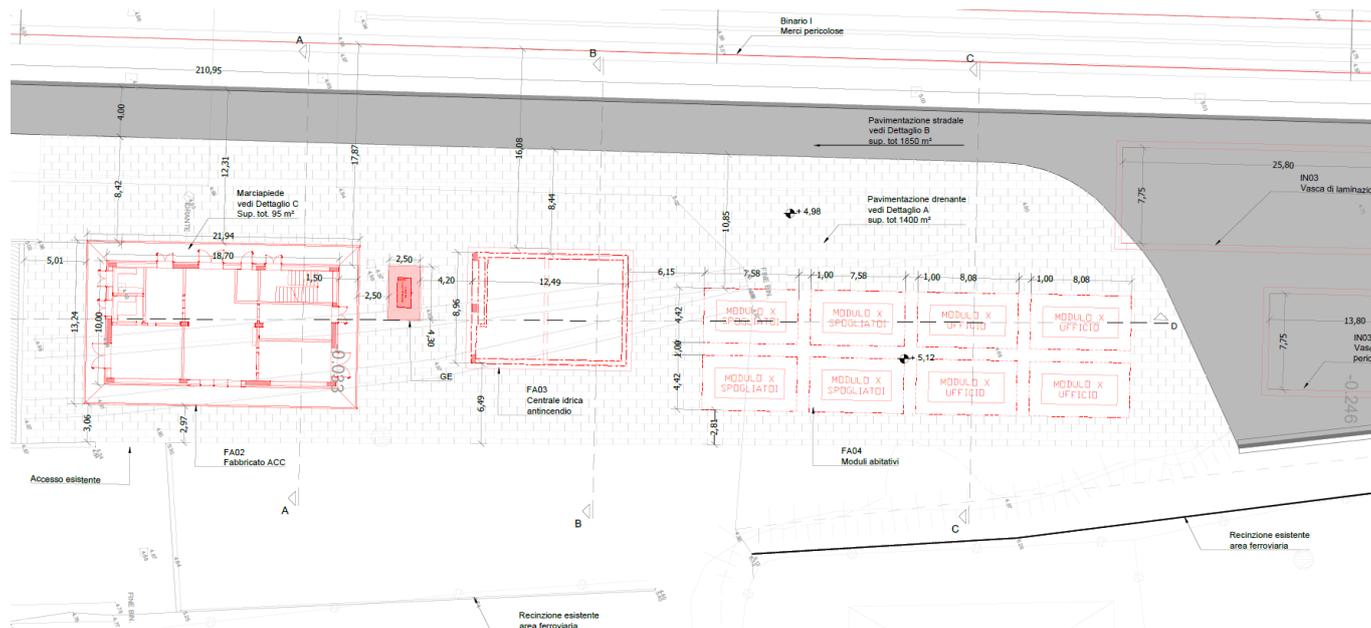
Planimetria piazzale esterno con FA02, FA03, FA04 e viabilità mezzi pericolosi
